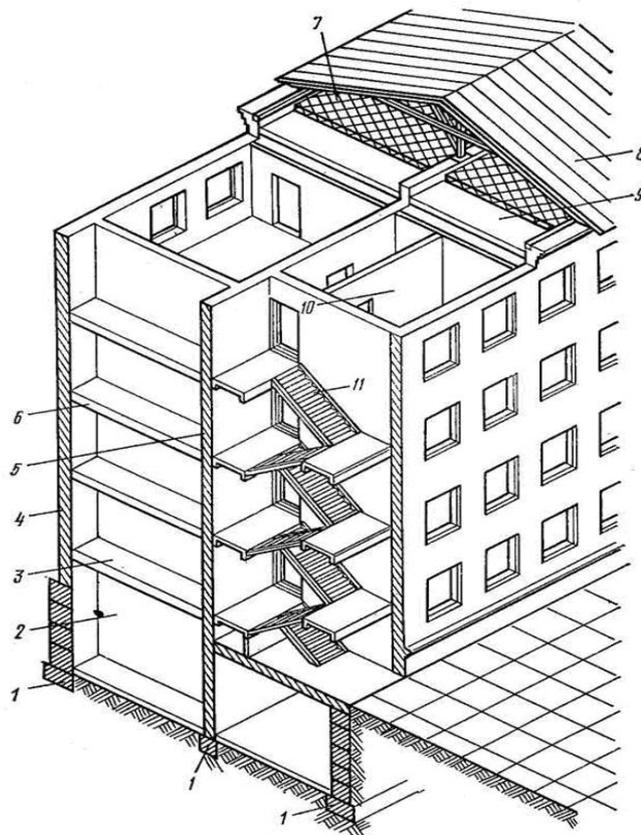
Конструкції багатоповерхового житлового будинку із цегляними стінами: 1 — фундамент; 2—підвал; 3—надпідвальне перекриття; 4 —
